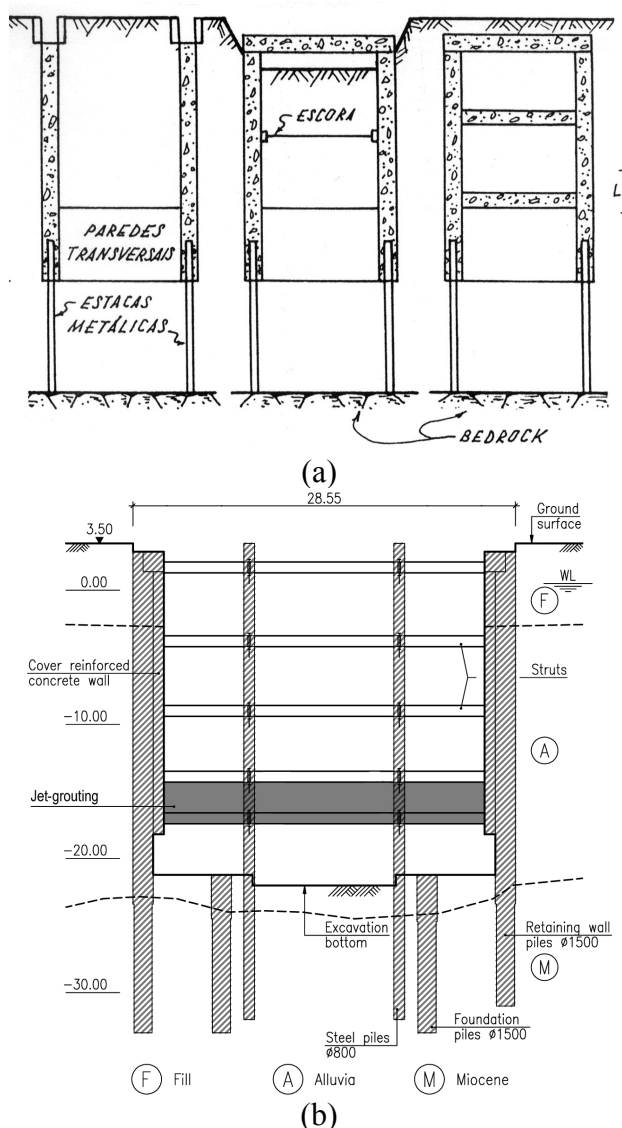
Soluções de tratamento-reforço de estruturas de suporte de escavações profundas em solos moles: a) painéis transversais de parede diafragma (Eide et al., 1972); b) laje de jet grout (Matos Fernandes et al., 2007)
